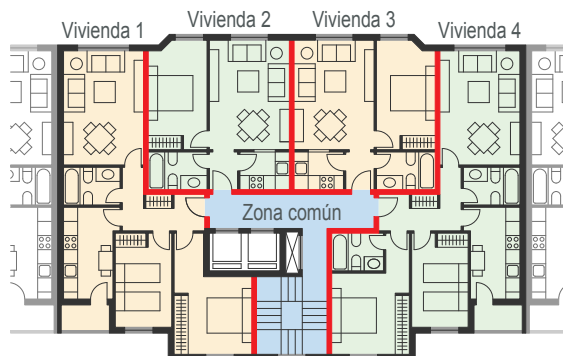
Separadoras entre viviendas y separadoras entre viviendas y zonas comunes.
